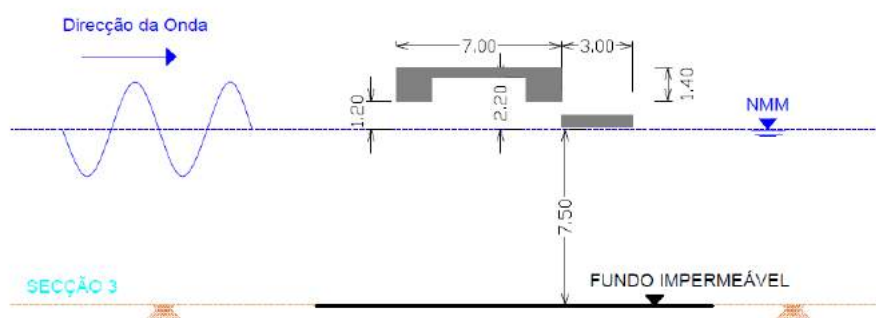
Secção transversal 3 da Ponte-Cais e respetivas dimensões em metros.
